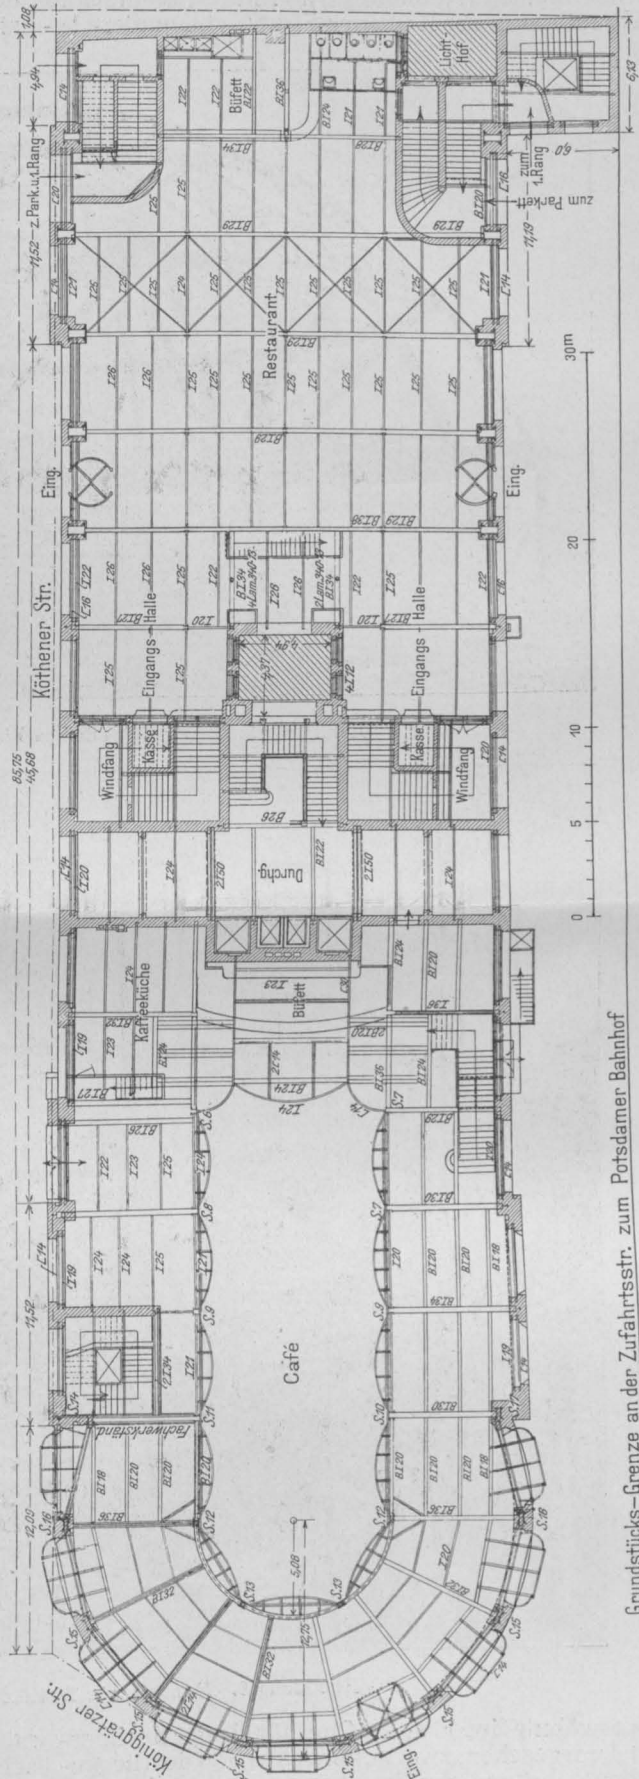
Grundriß in Höhe des I. Stockwerkes. (Trägerplan in Galeriehöhe des Saales.) Abbildung 1 (unten). Grundriß des Erdgeschosses. (Trägerplan der Decke.)
